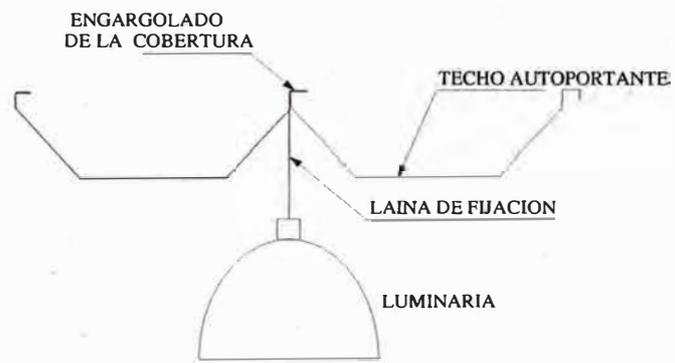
Detalle de los elementos de sujeción (lainas).
